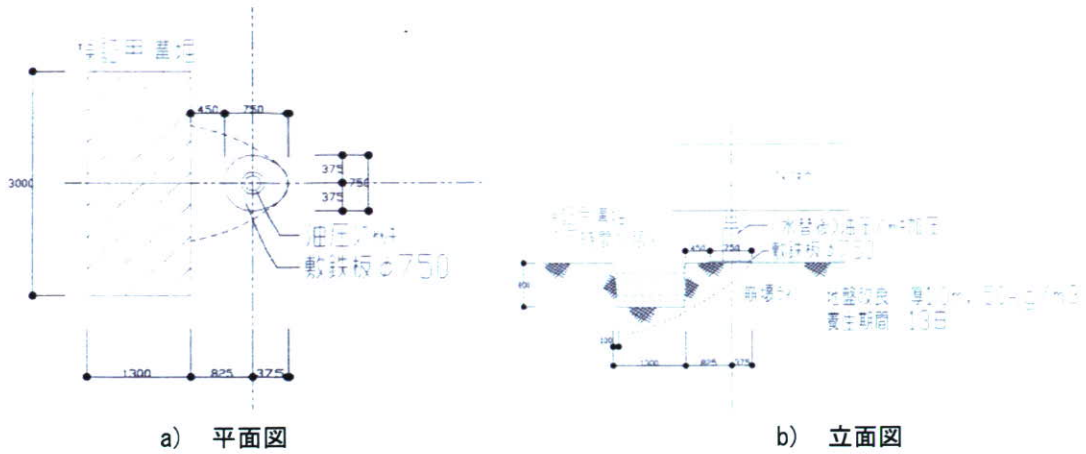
Case1-1 の平板載荷試験の実施位置の詳細
